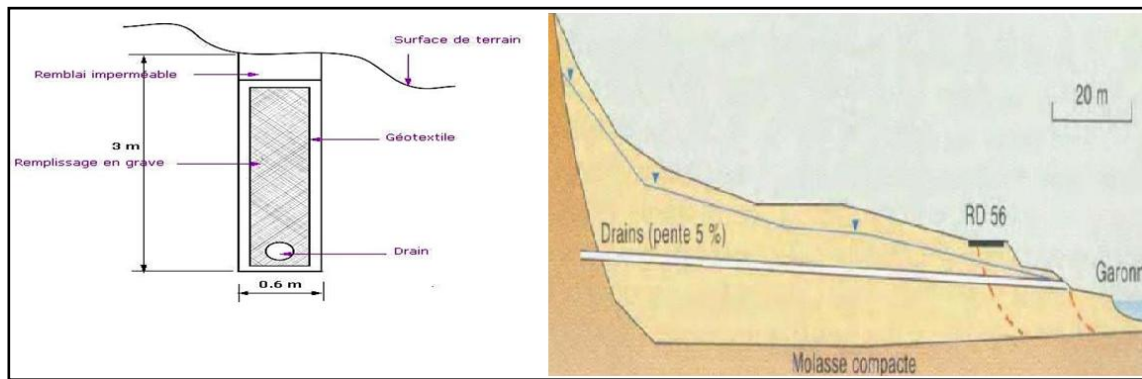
Drains subhorizontaux « Stabilisation par drains subhorizontaux de la RD à Muret (Haute-Garonne, France) »
